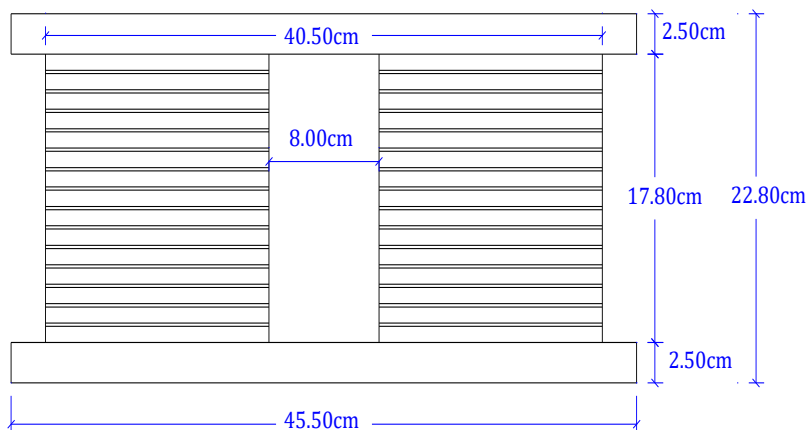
Dimensiones de Aislador LRB para puente preesforzado.
